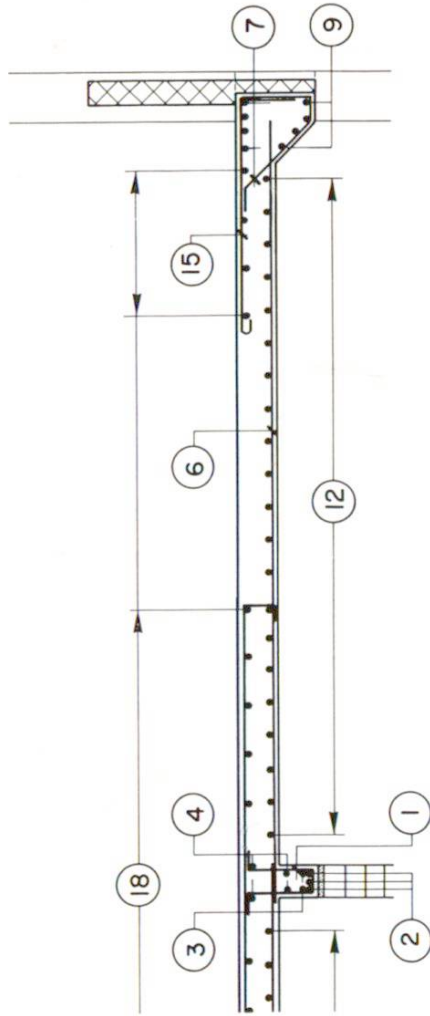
Exemple d'utilisation de la liste de pose, en combinaison avec le plan d'armature
